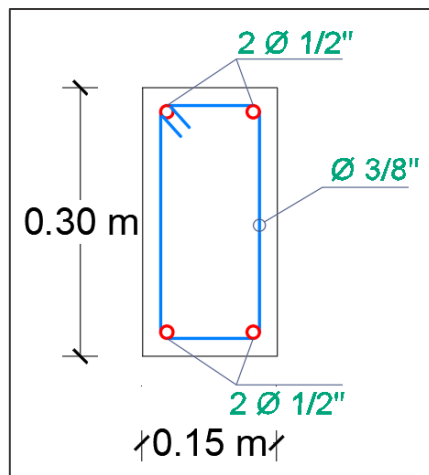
Sección transversal del diseño de viga, Fuente: Elaboración Propia.
